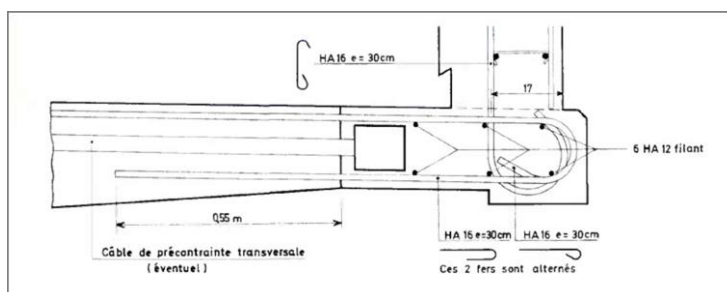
Exemplo da pormenorização da ligação barreira-tabuleiro, de acordo com o SETRA [10]
